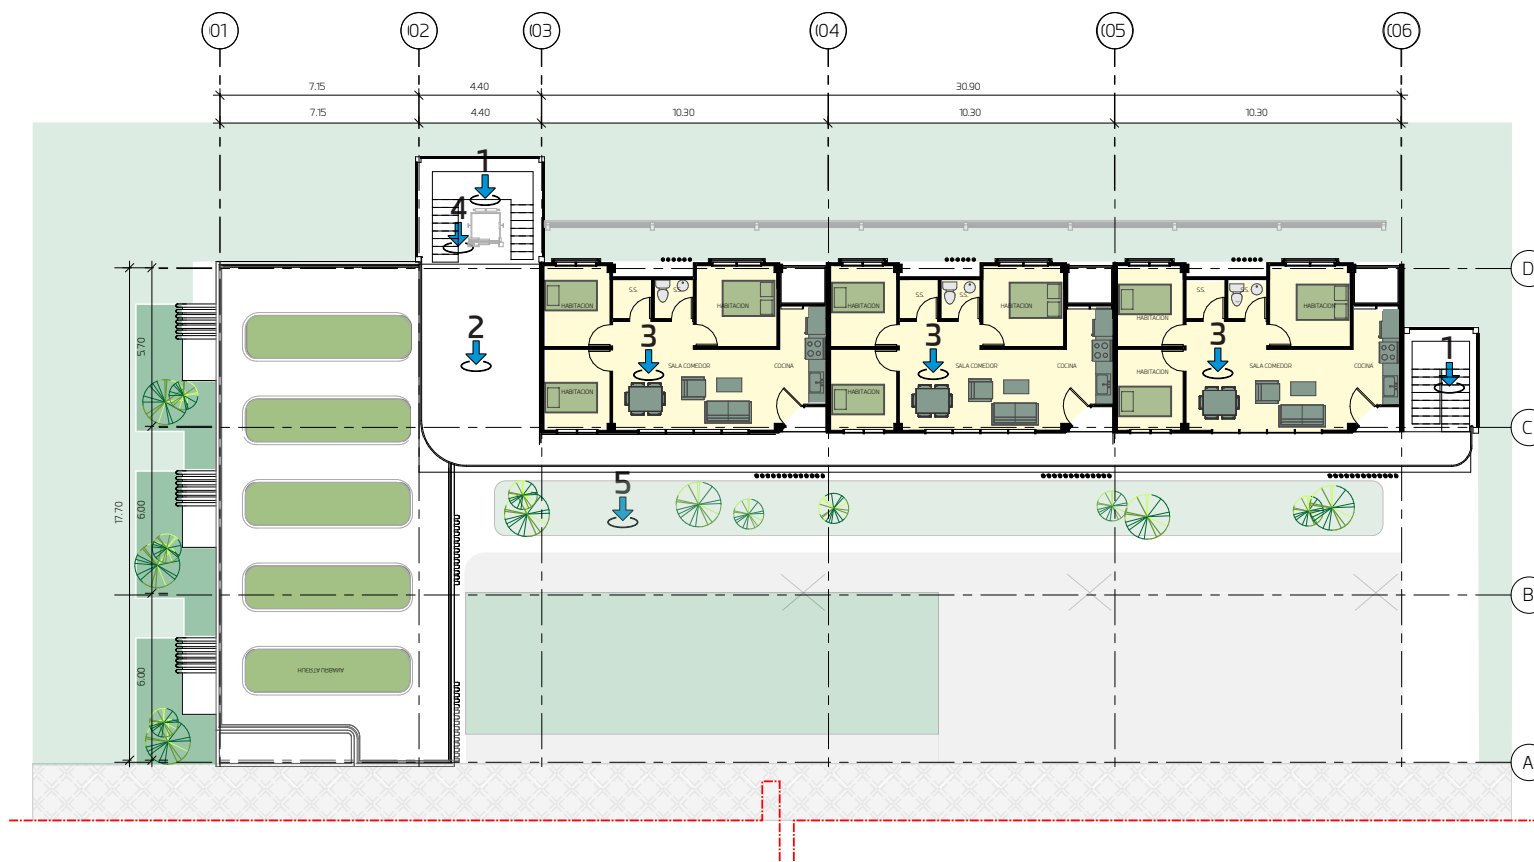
Planta de distribución general de quinto nivel por módulo
